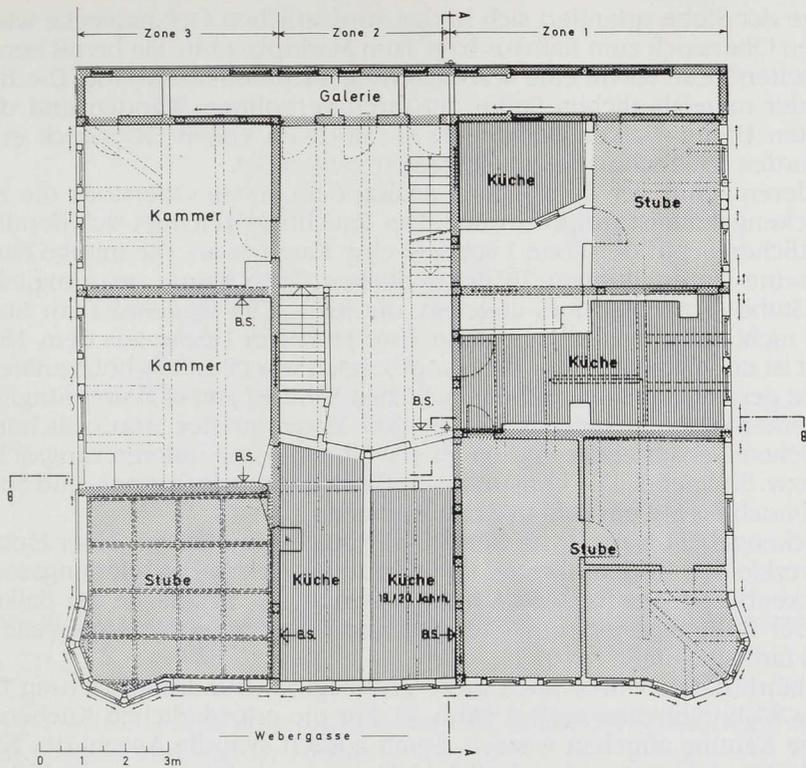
Blaubeuren, Großes Haus, Grundriß zweiter Oberstock. Rekonstruktion der erweiterten Grundrißgliederung des 18. Jahrhunderts.
